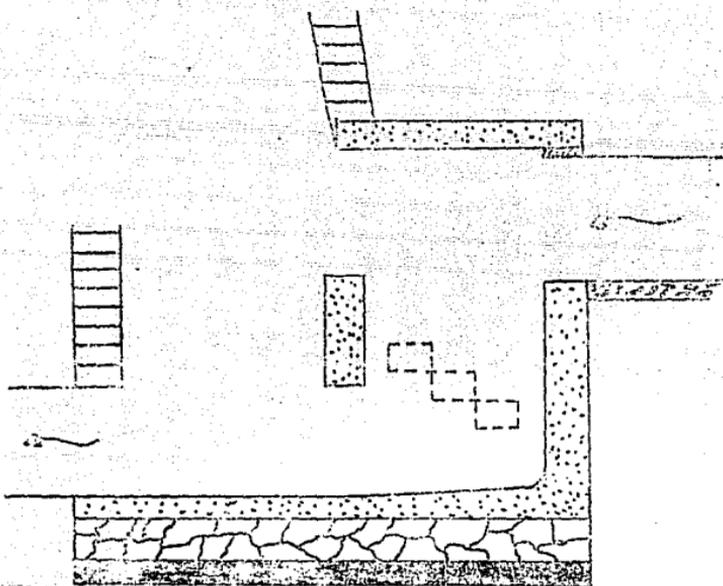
(b) Pozo con caída en tubería de 0.3 a 0.76m de diámetro.
